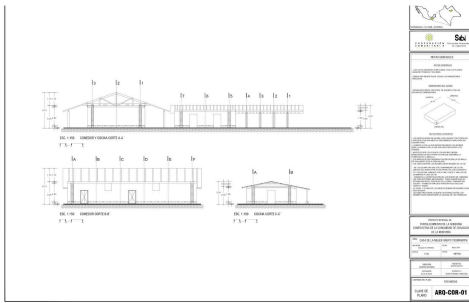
Corte longitudinal y transversal (ARQ-COR-01)
